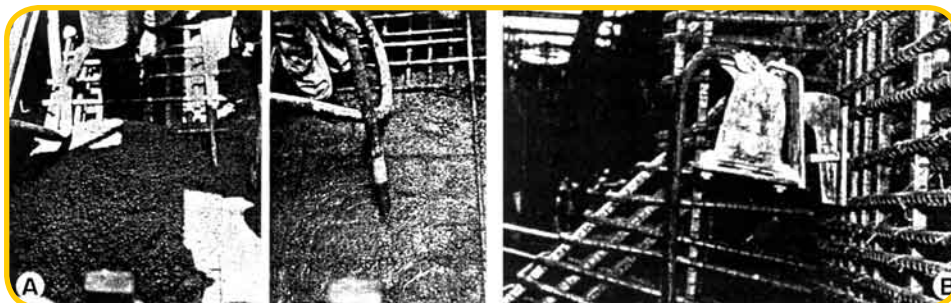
(A) Vibrador de imersão utilizado no lançamento do concreto; (B) equipamento vibratório acoplado diretamente na armadura durante o lançamento do concreto, utilizado nos navios da Nacional City
